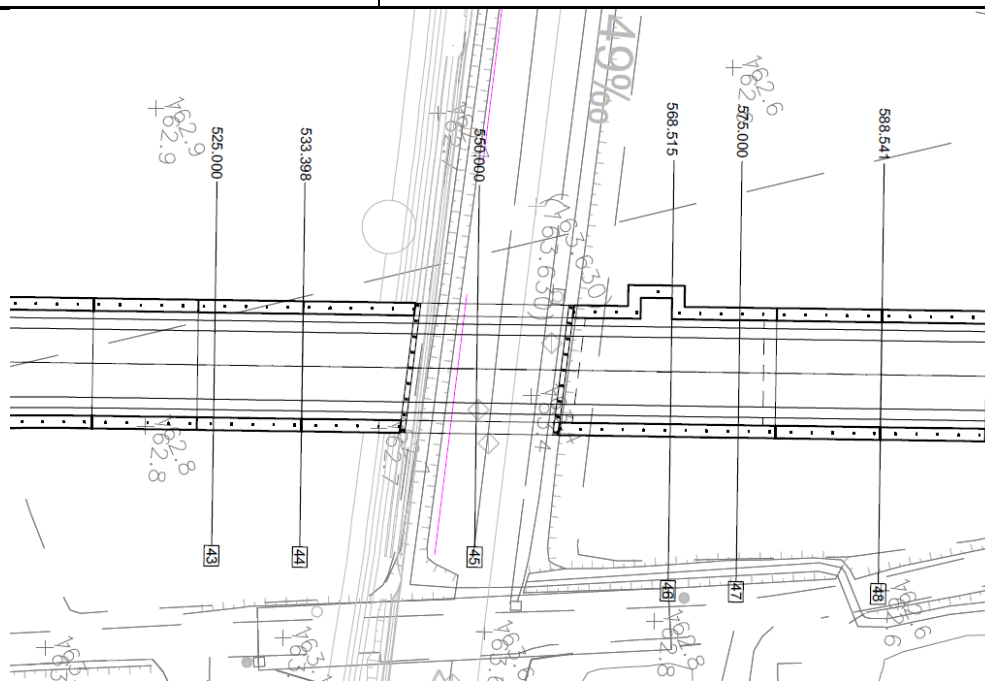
PLANIMETRIA SOTTOVIA SL03
